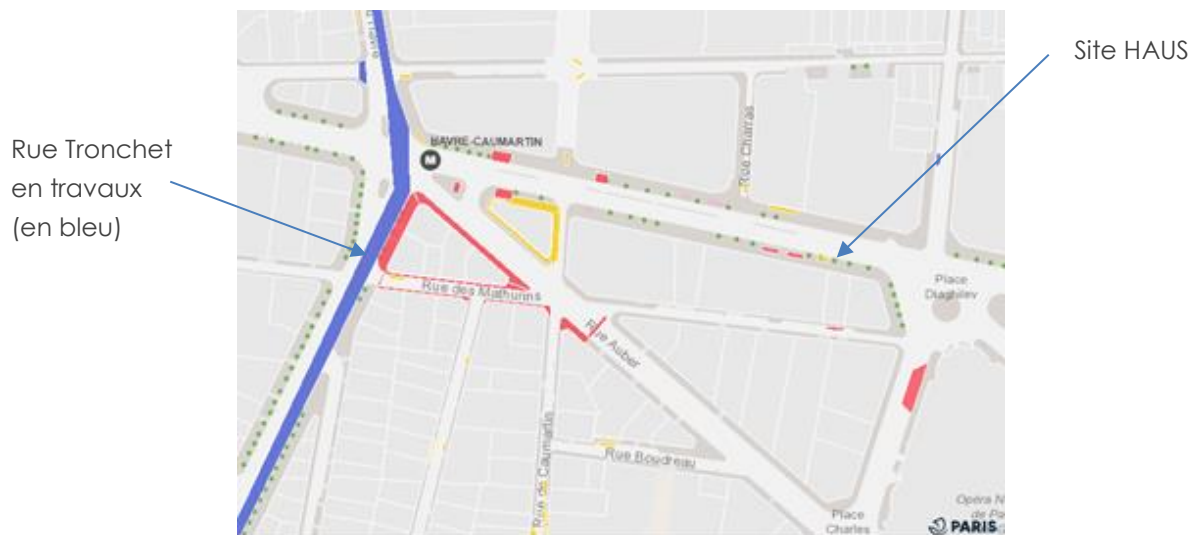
Source Ville de Paris, plan de situation des travaux de la rue Tronchet et du site HAUS
